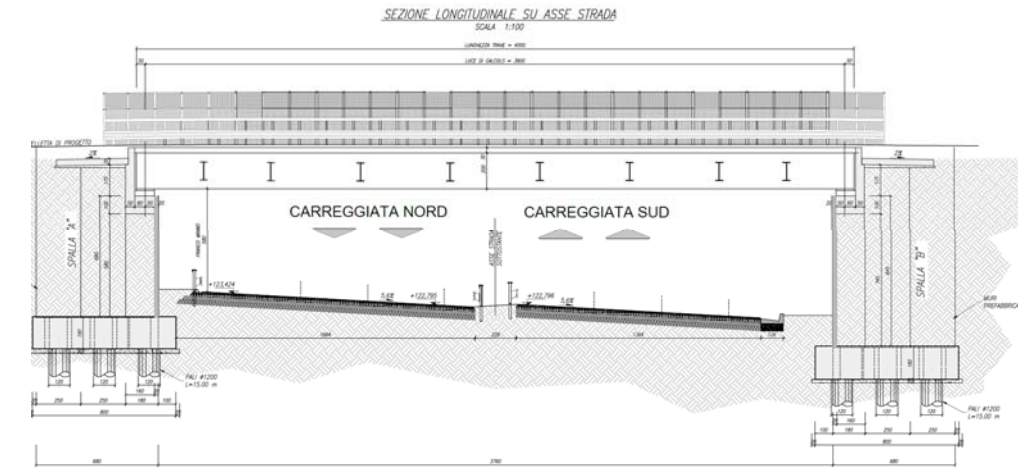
Cavalcavia al Km 11440: Sezione Longitudinale
